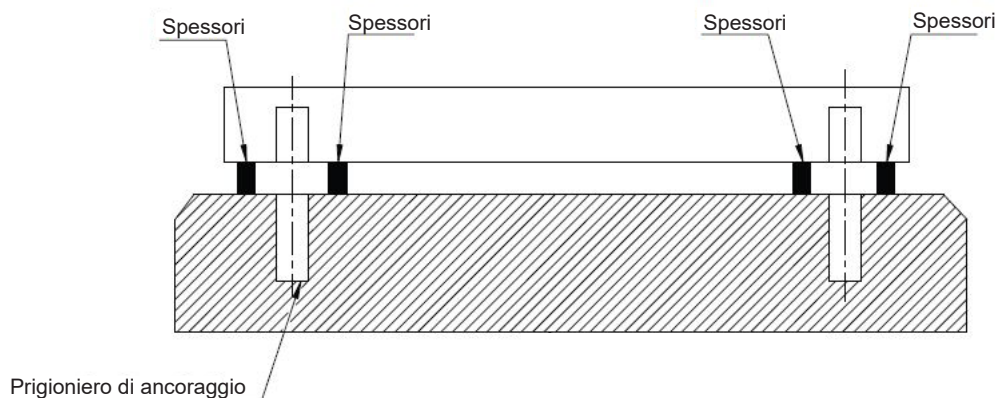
Applicazione fondazioni in calcestruzzo, lama e ancoraggio
